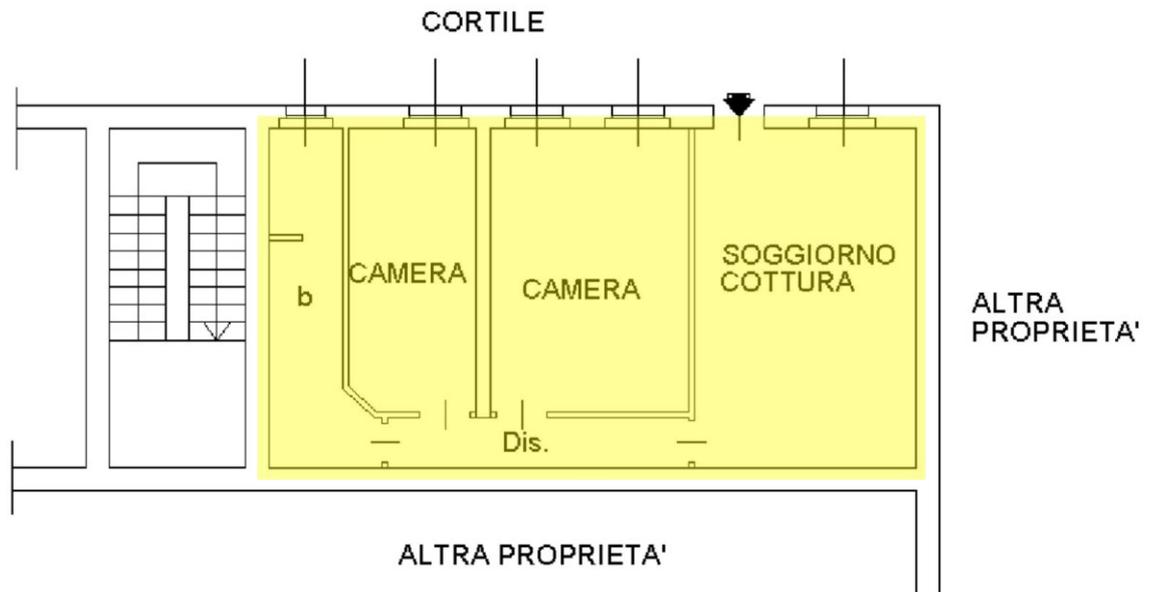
Planimetria dell'appartamento (evidenziato in giallo)
